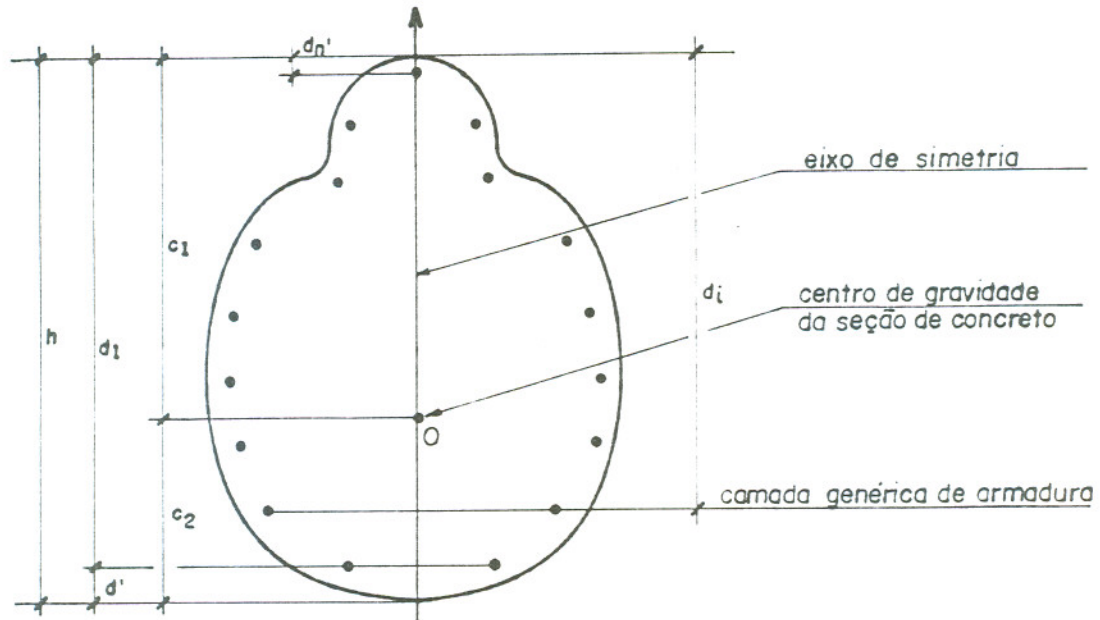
Seção genérica de concreto armado, com um eixo de simetria.
